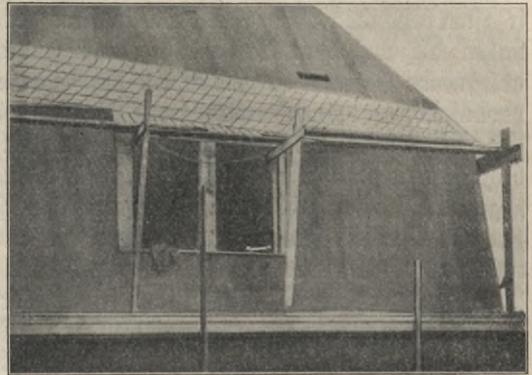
Mangelhaftes Dachgerüst an einem Neubau in Köln-Marienburg.
